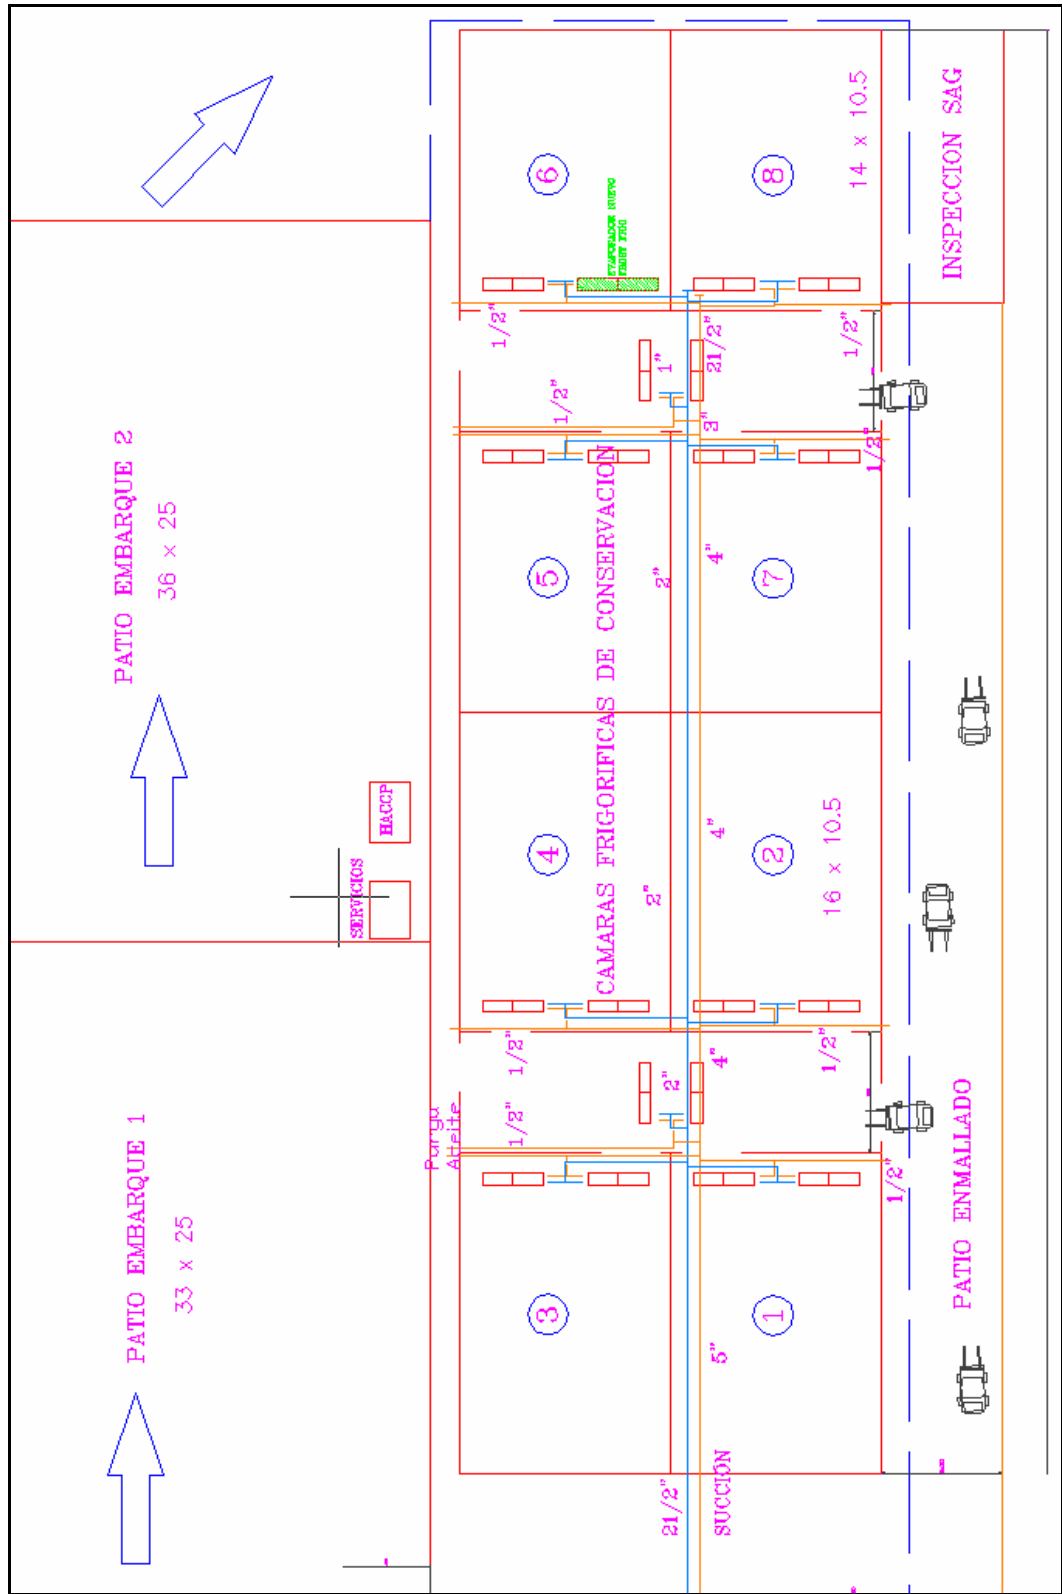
Cámaras de almacenamiento de la planta Aconex Coquimbo
